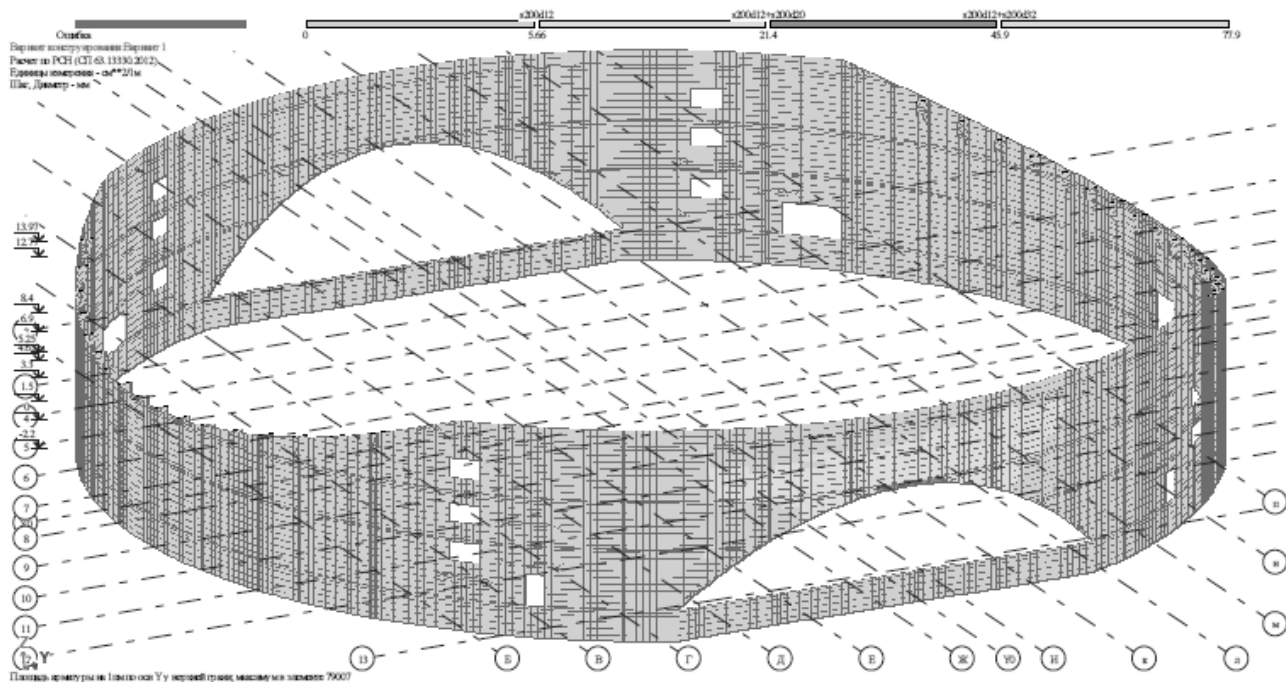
Расчетное армирование стен по оси Y у нижней и верхней грани
